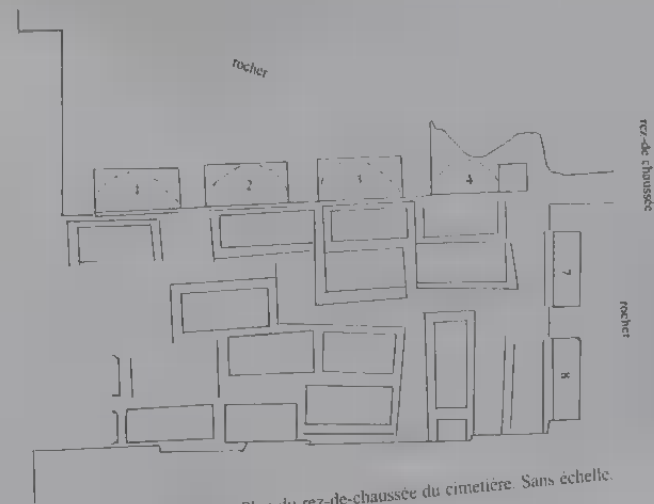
Samos. Plan du rez-de-chaussée du cimetière. Sans échelle.
